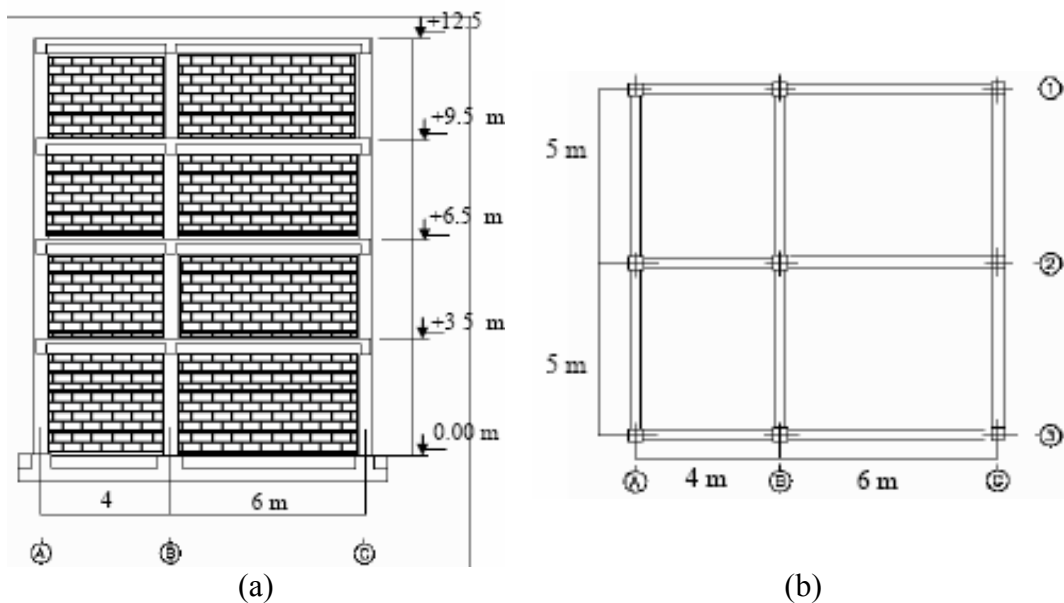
a) Vista Lateral de los pórticos de la estructura, b) Vista de planta de la estructura.
